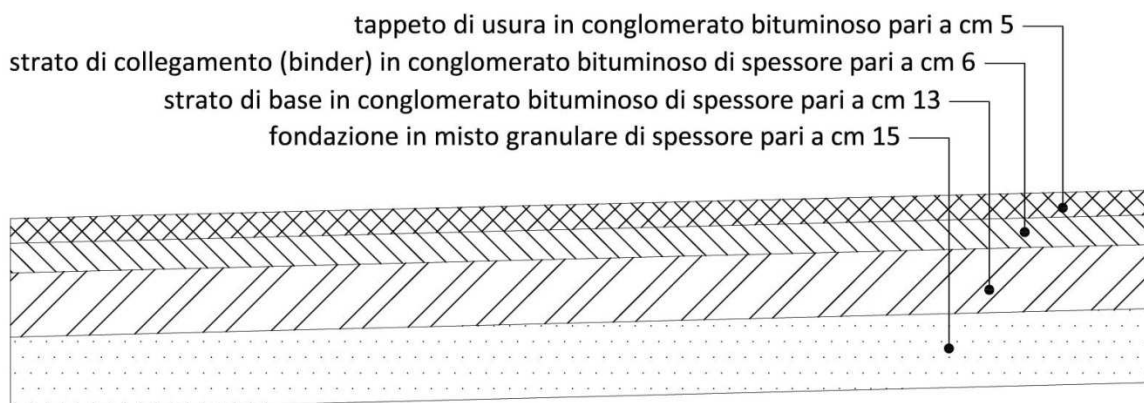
Particolare della pavimentazione delle rampe 4, 5, 6 e 7
